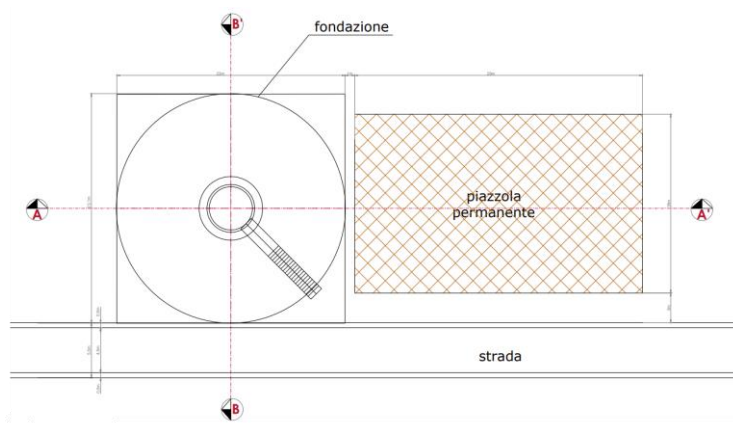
Piazzola definitiva tipo (pianta e sezioni)
